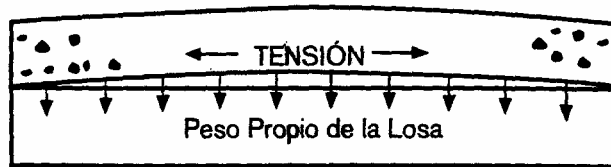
Agrietamiento Inicial en un pavimento de concreto sin juntas.
